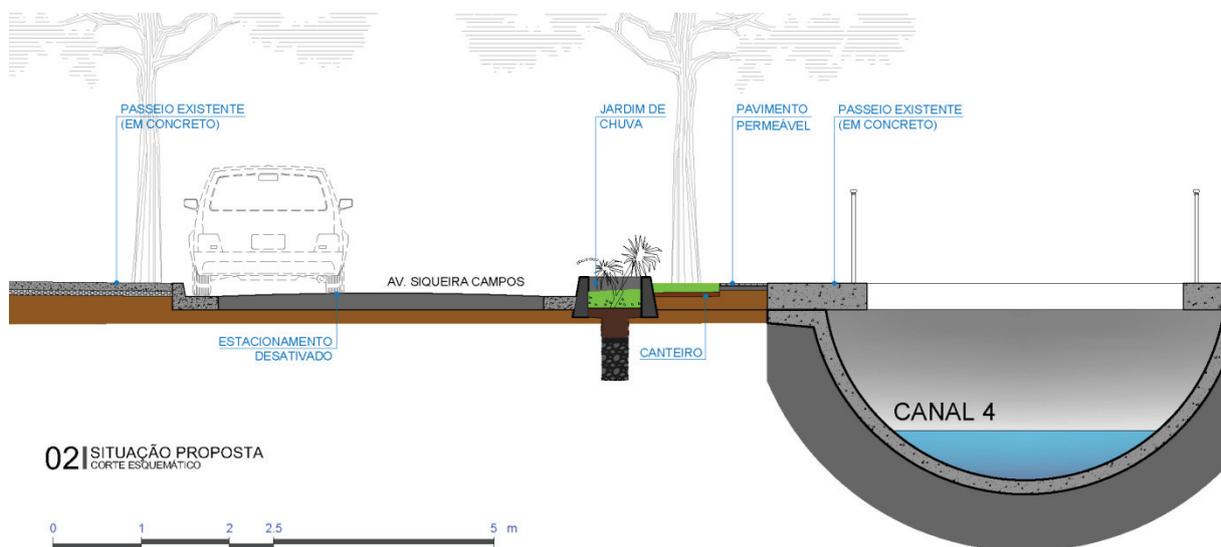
Canal 4 – situação proposta. Fonte: Desenho da autora
